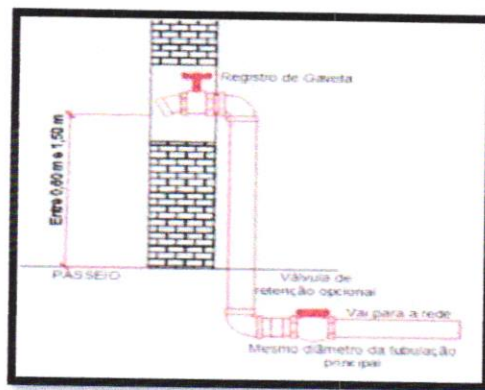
Hidrante Recalque na Fachada ou muro de divisa
